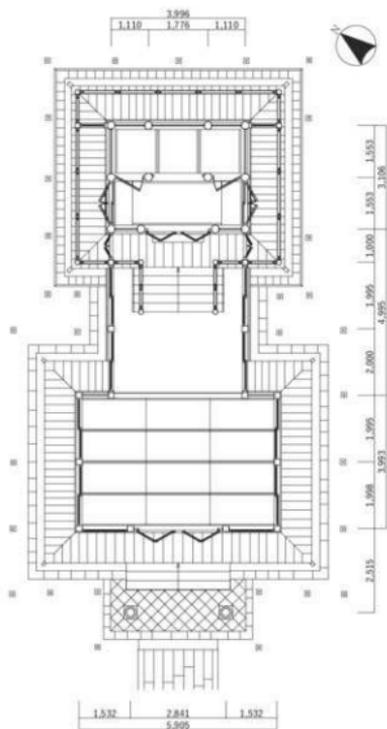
旧井伊神社本殿、石の間および拜殿平面図
